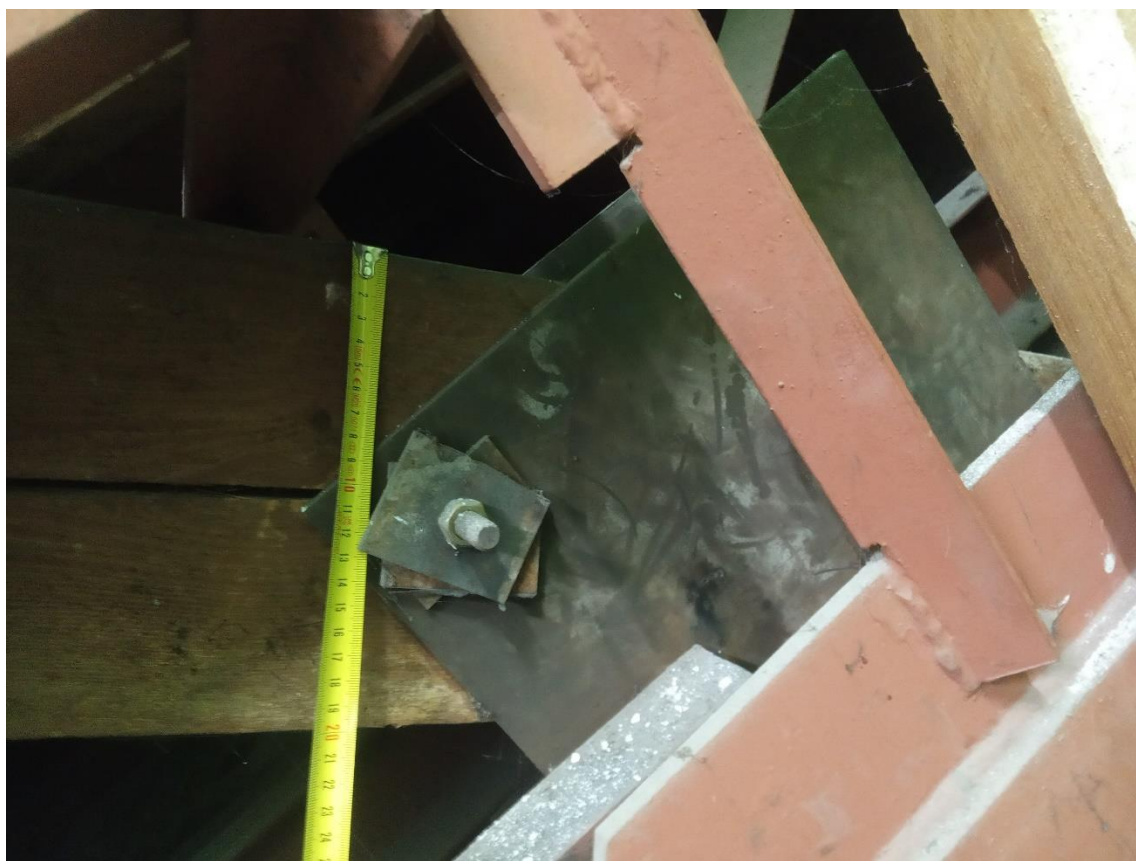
Spękanie w połączeniu konstrukcji dachu płaskiego z więźbą dachu stromego w osi „2”.
